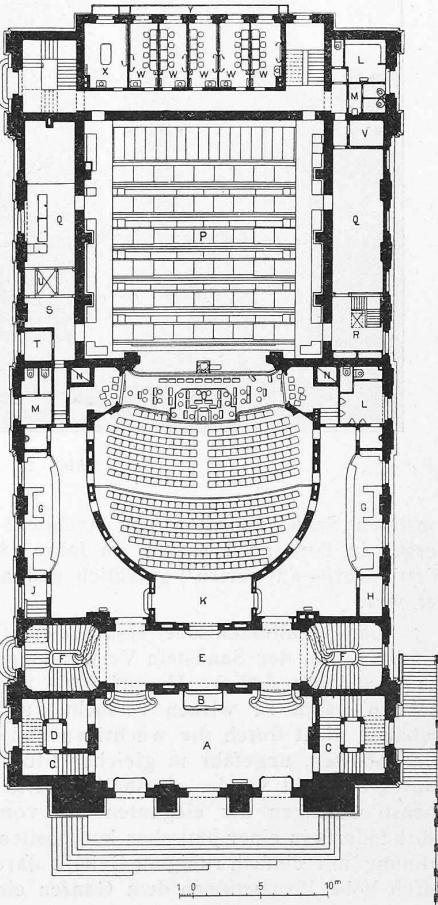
Grundriss vom Erdgeschoss. 1:500.
